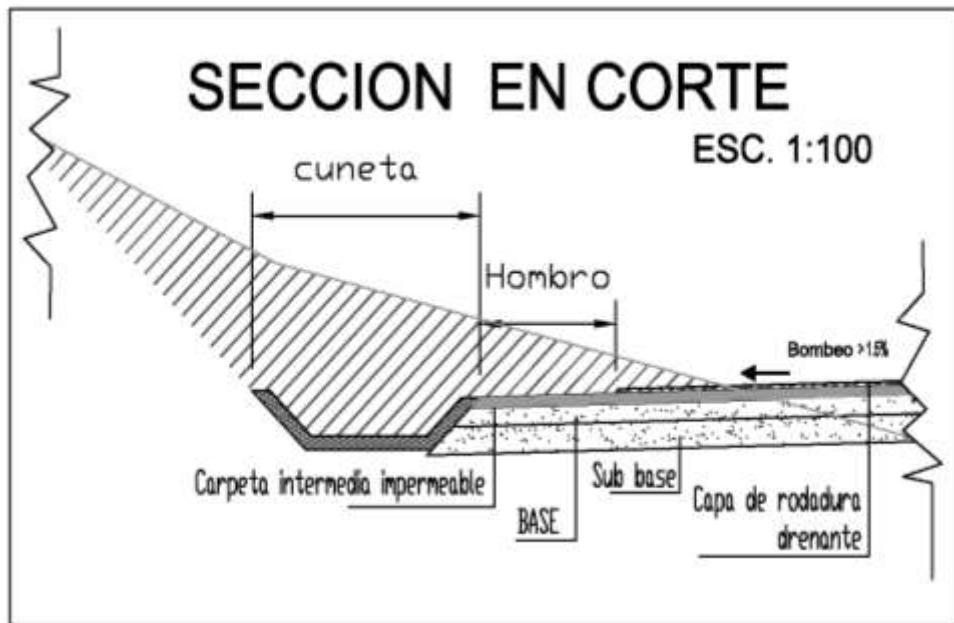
Sección Transversal en Corte de un Pavimento con Capa de Rodadura Drenante.
